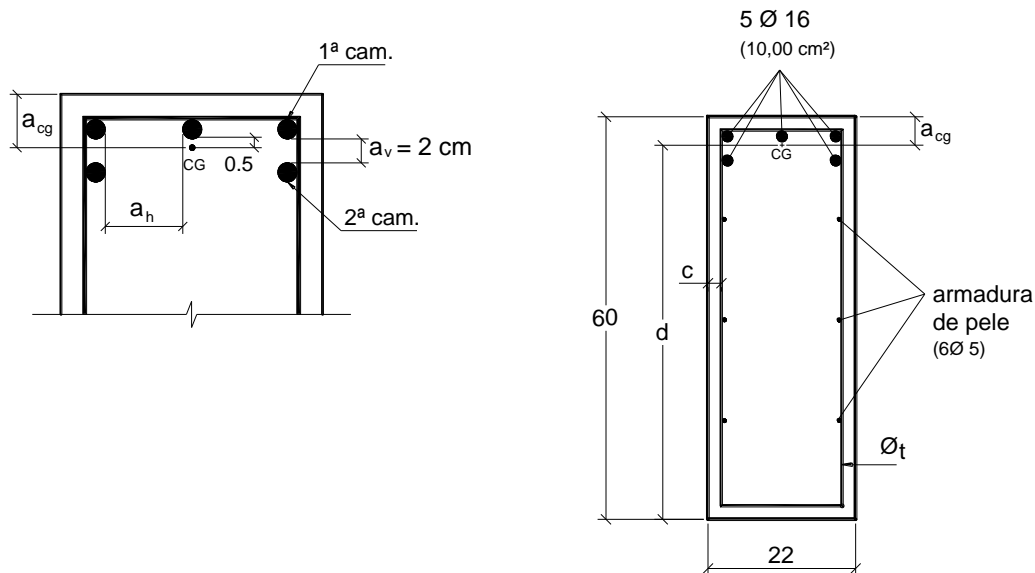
Detalhamento da armadura negativa na seção transversal.
